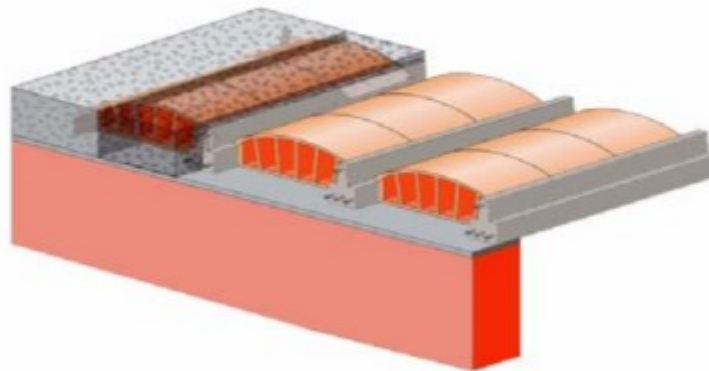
Pavimento de vigotas pré-fabricadas
